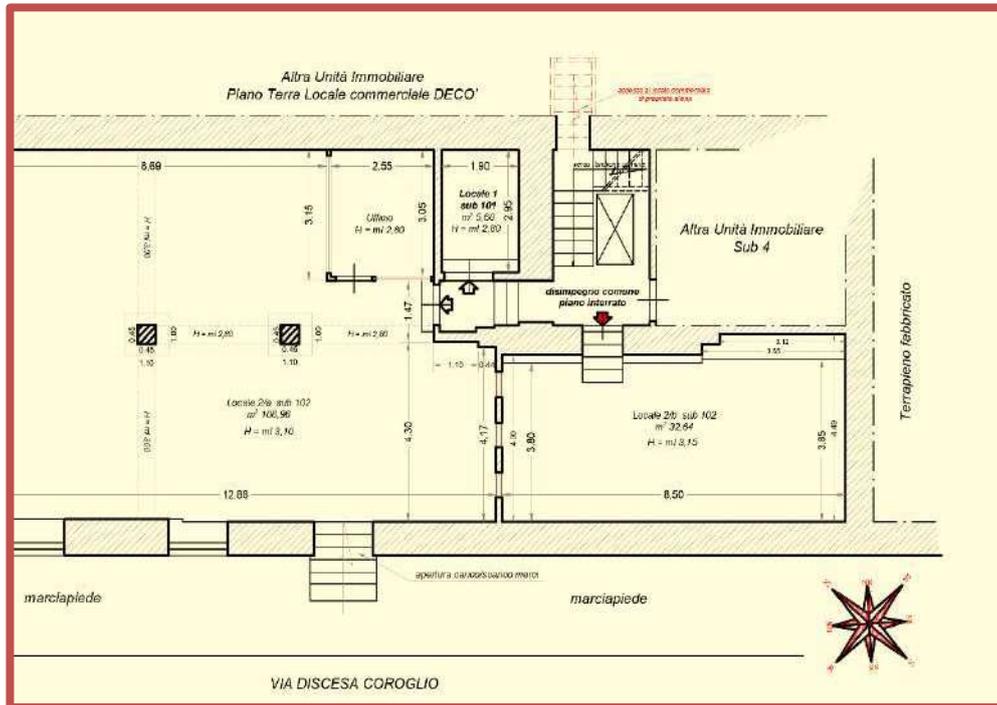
Stralcio planimetrico fuori scala dell'accesso al "Locale 2/b Sub 102".
